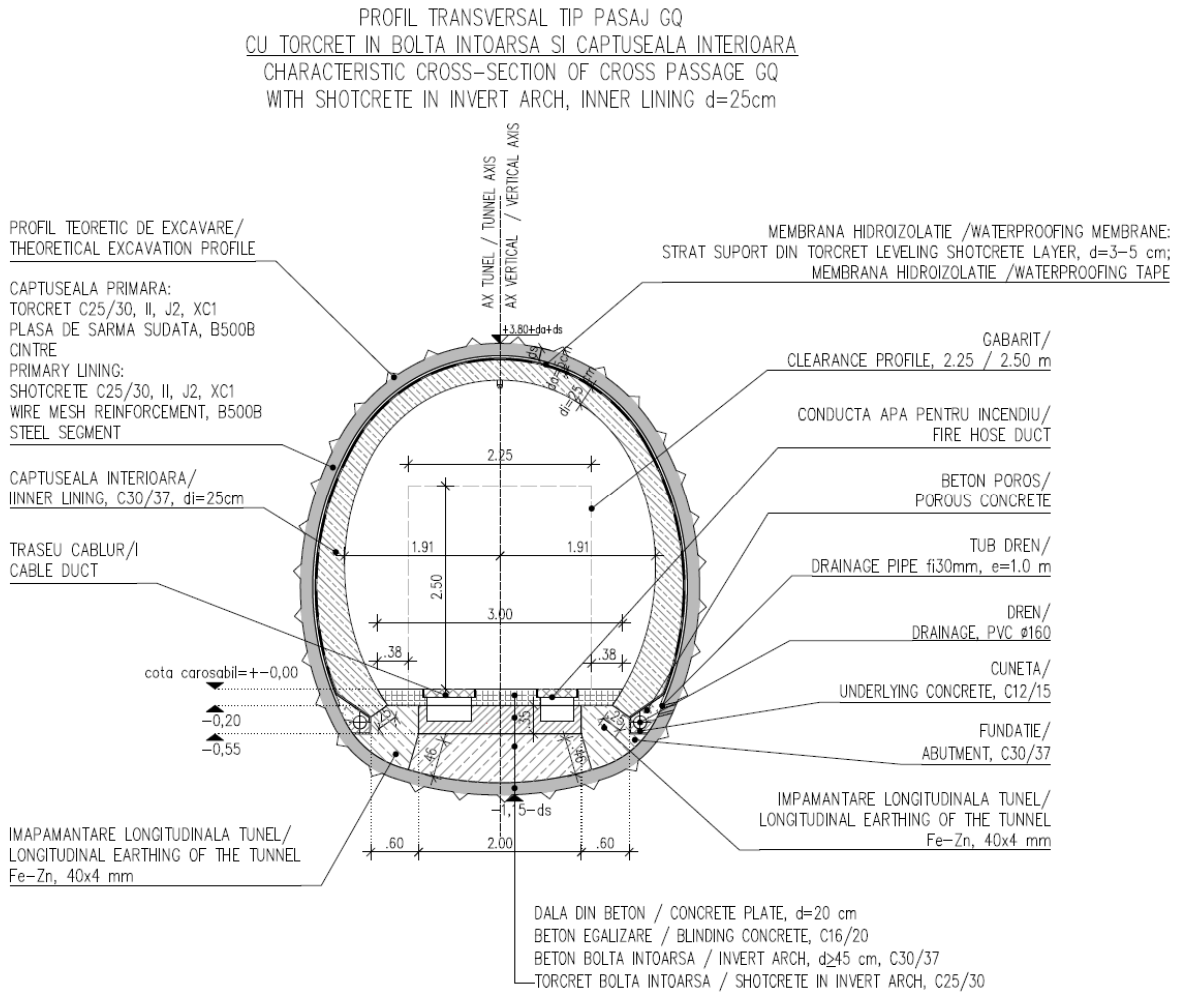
Secțiune transversală tip a galeriei pentru evacuarea pietonilor GQ
